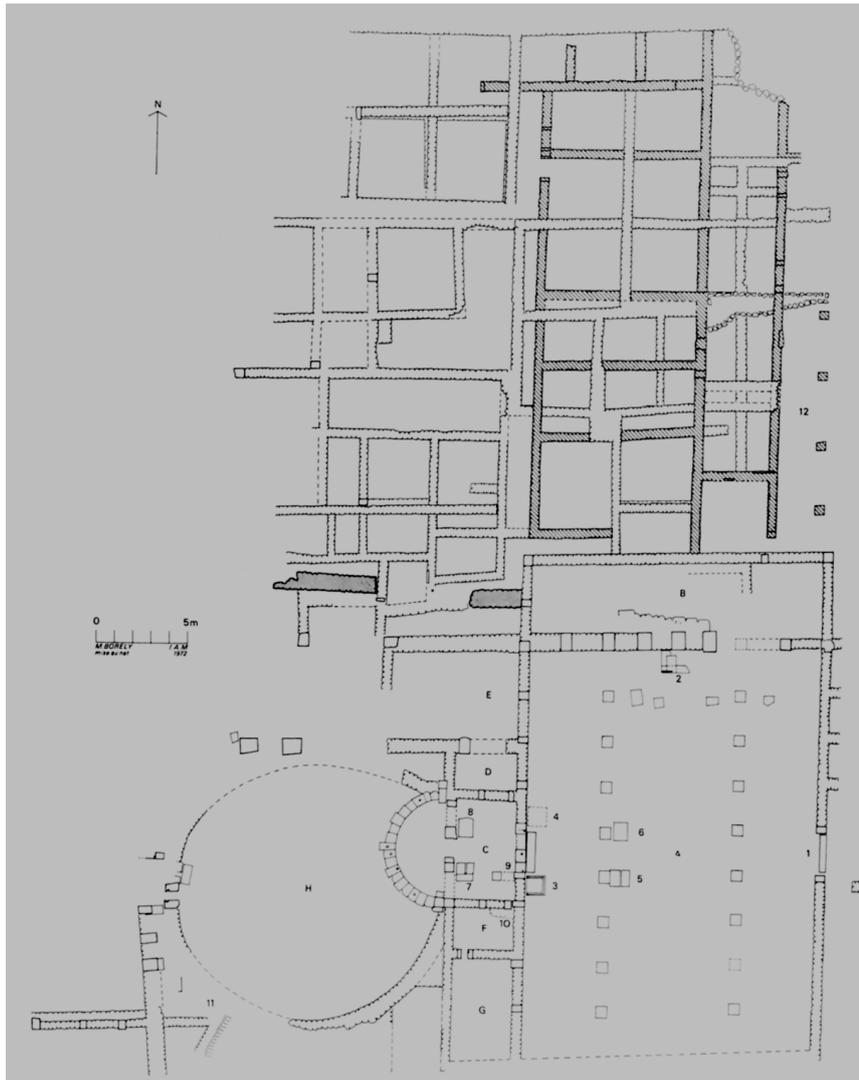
pianta della parte centrale dell'accampamento est (da: JANON 1973, p. 206).
